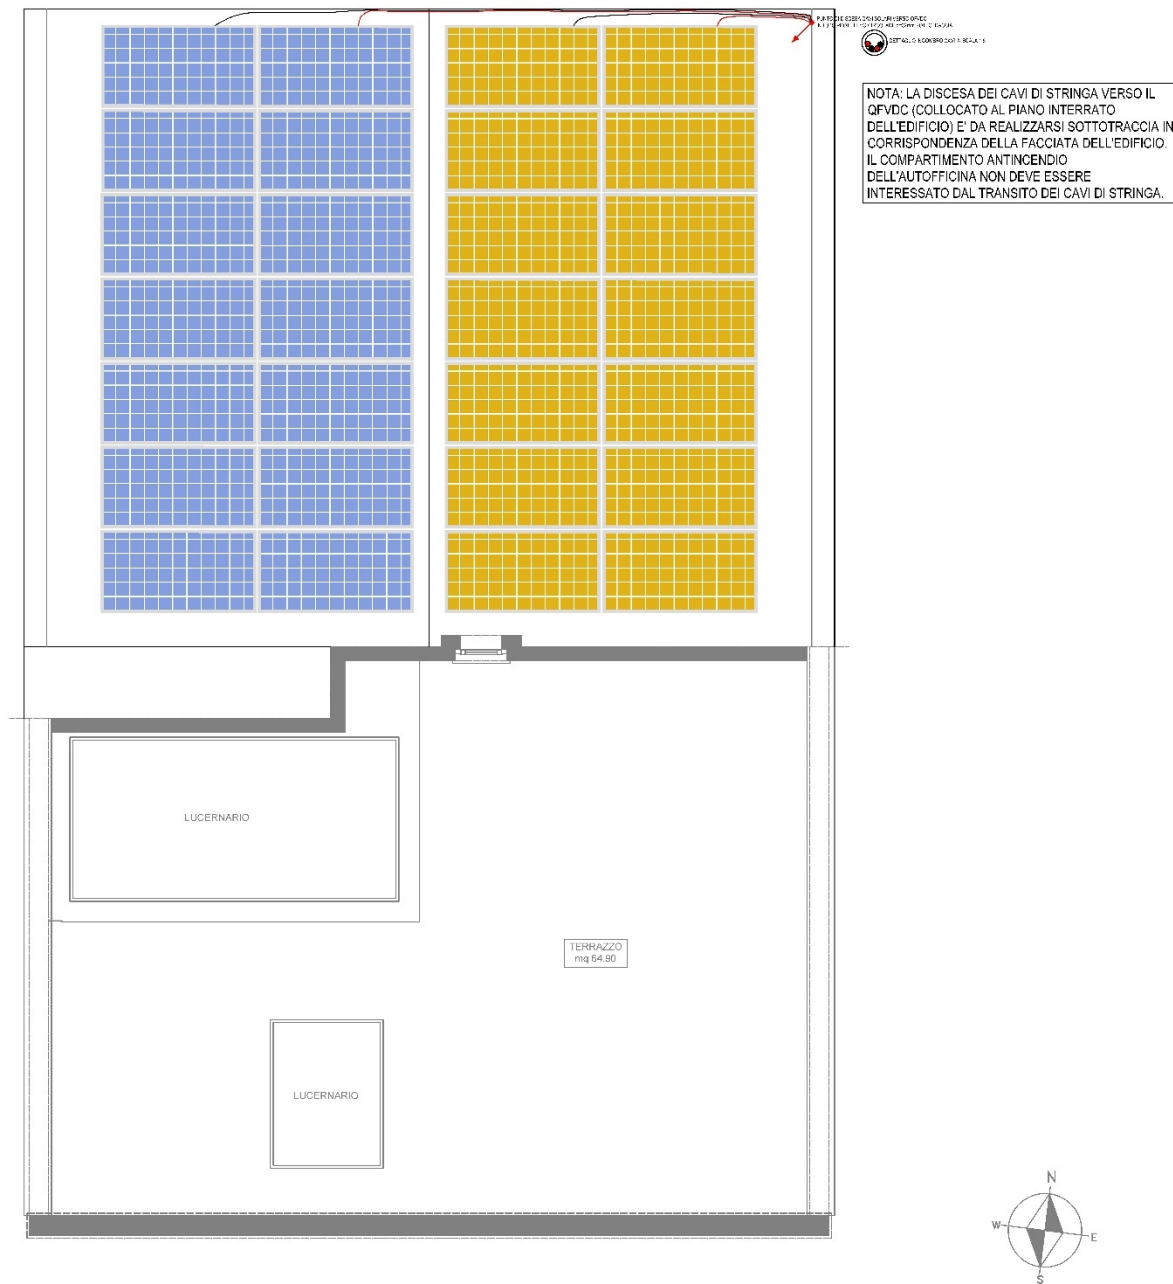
Disegno planimetrico con il layout dei moduli fotovoltaici posizionati sulle falde del tetto
